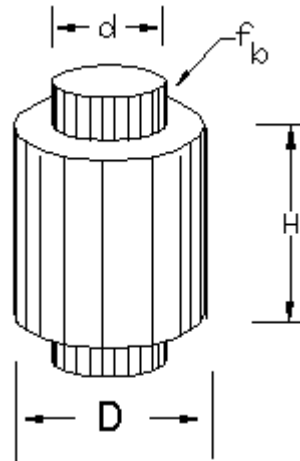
Cilindro submetido à compressão axial (ADEBAR & ZHOU, 1993)
